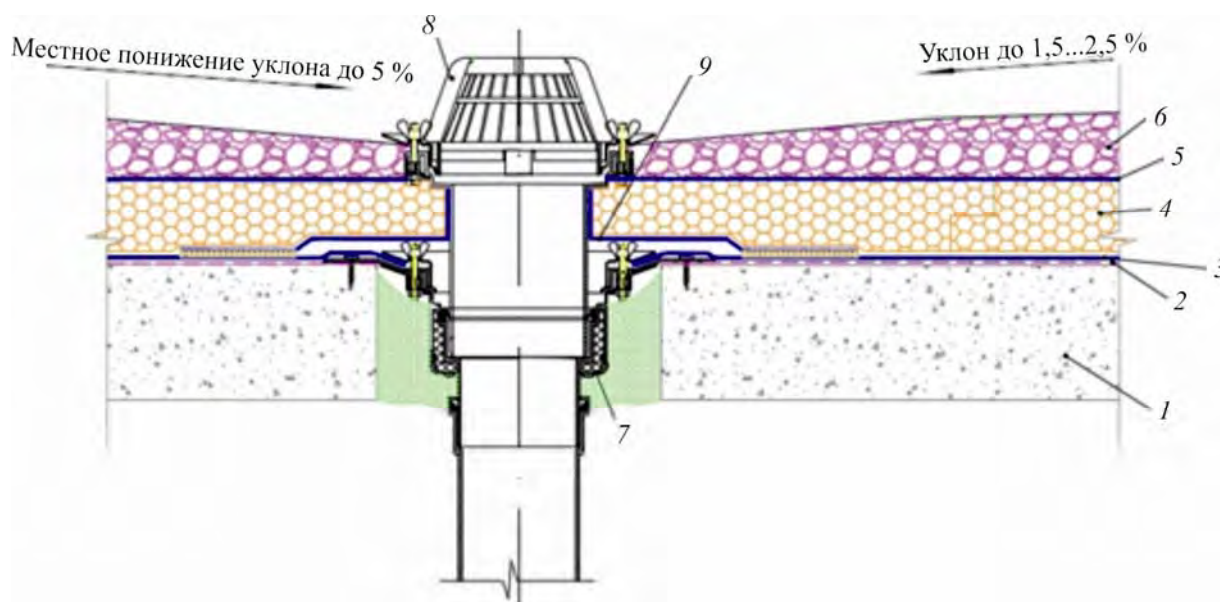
Узел примыкания водосточной трубы к покрытию: 1 — железобетонная плита перекрытия; 2 — грунтовочный слой; 3 — гидроизоляционный ковер из рулонных материалов; 4 — экструдированный пенополистирол; 5 — фильтрующий материал; 6 — дренирующий слой гравия; 7 — металлический фартук; 8 — колпак водосборной воронки; 9 — дополнительный слой гидроизоляции
